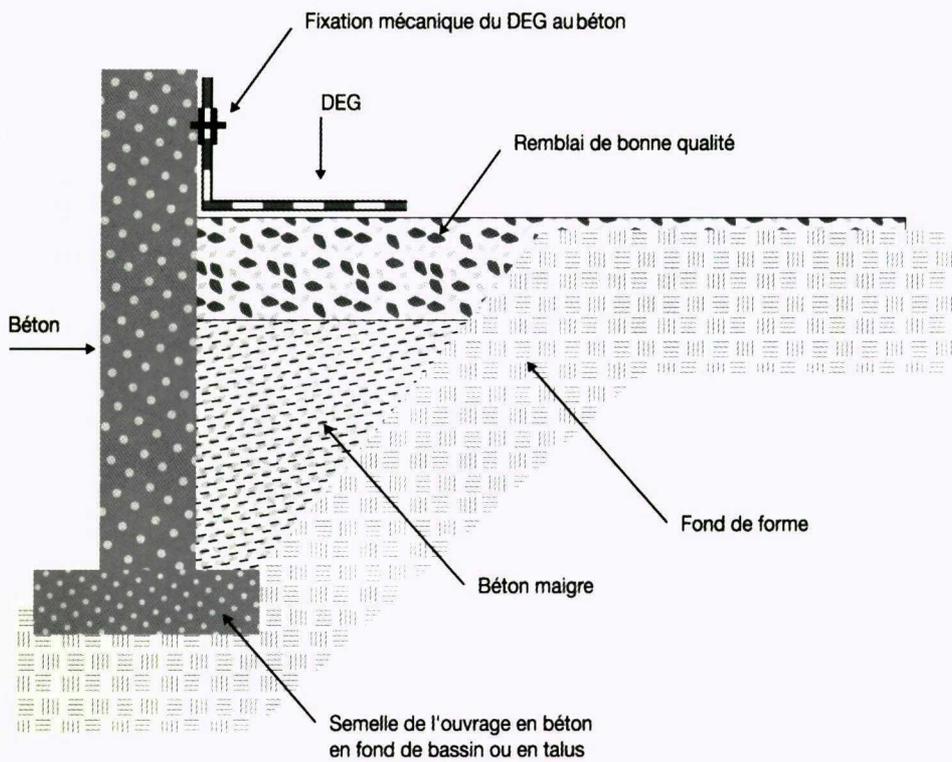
Raccordement d'une géomembrane sur un horizon étanche en fond d'ouvrage.
